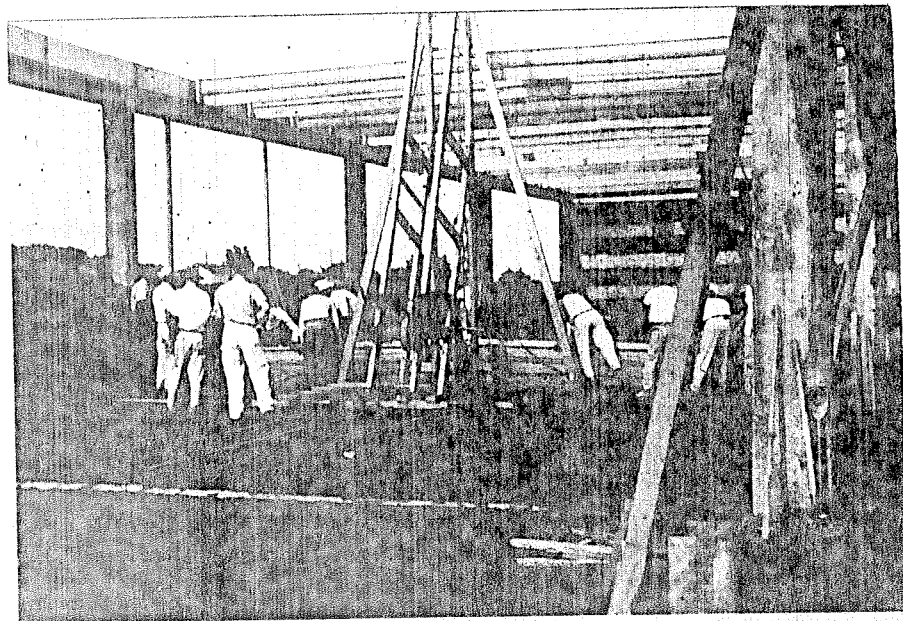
Montagem dos primeiros perfis pré-moldados de argamassa armada, utilizados em instalações da EESC-USP.
